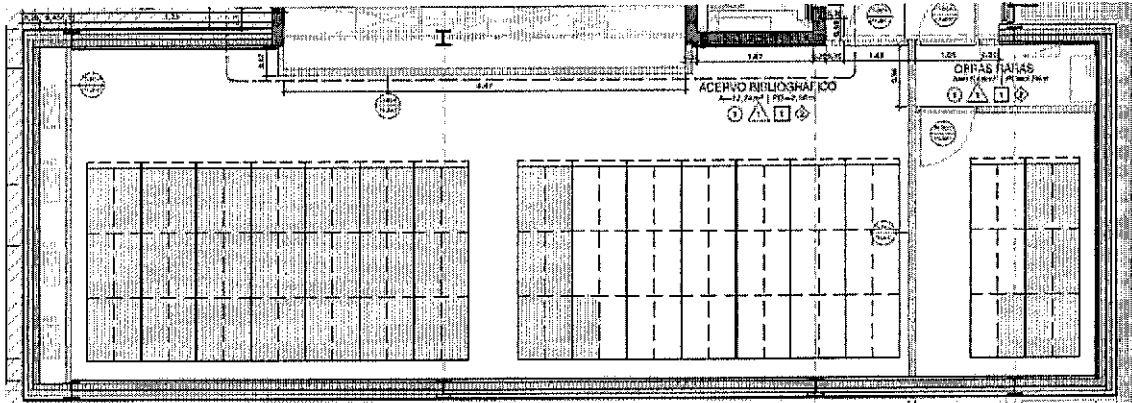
planta do 3º pavimento do objeto licitado, com área de arquivo com 88,42m².
